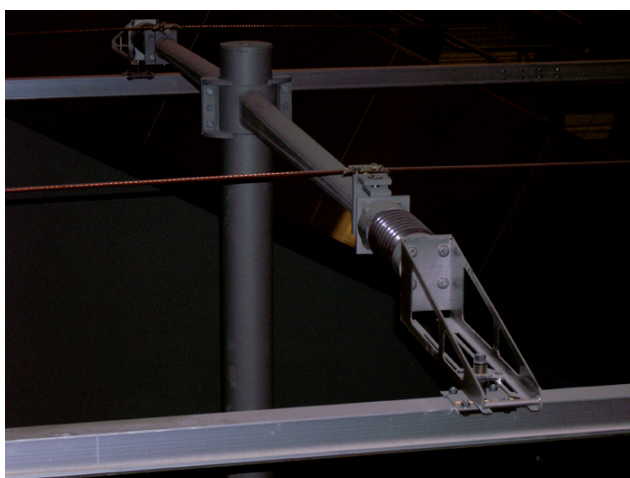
Wnętrze hali – wyjazd w kierunku wschodnim
